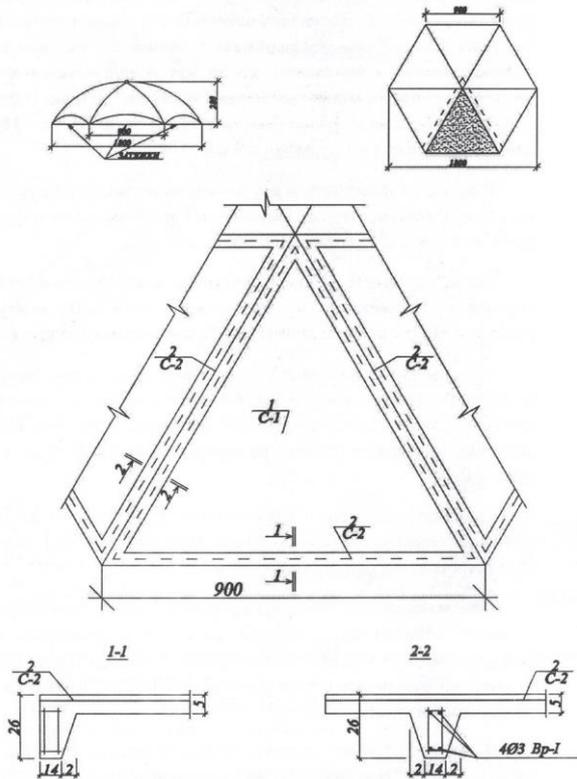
Схема и армирование модели секториальной оболочки положительной гауссовой кривизны: 1 – сетчатое армирование поля оболочки; 2 – то же приконтурных и угловых зон.
